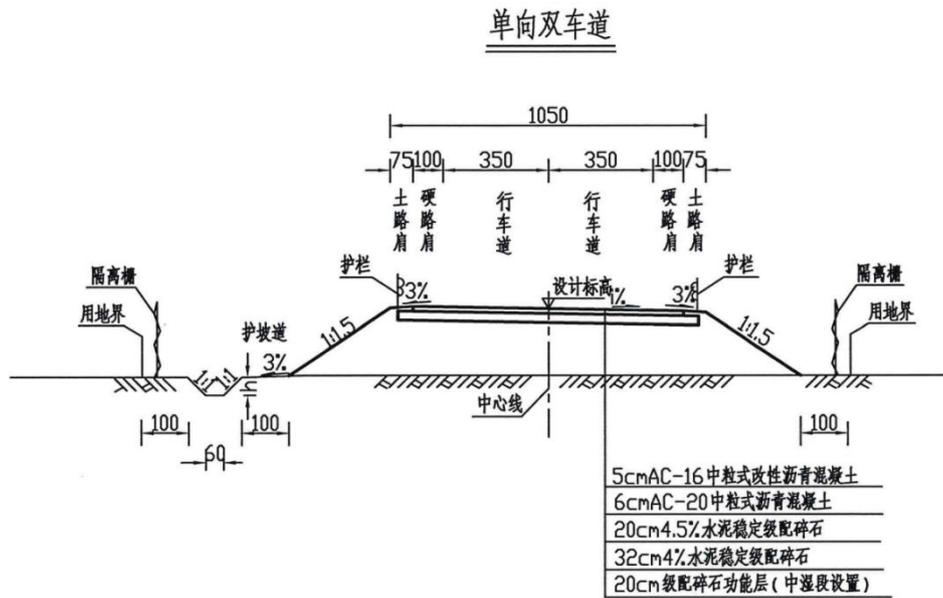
曙光互通式匝道路基标准横断面图 (单向双车道)
